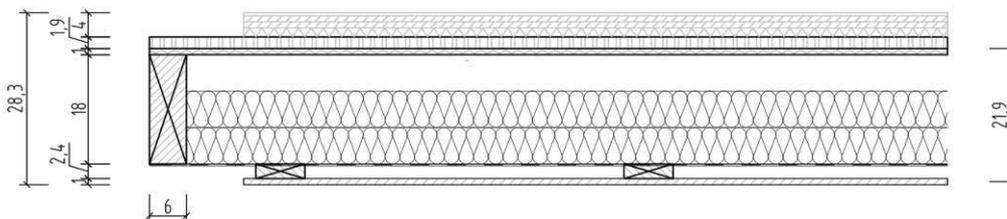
Geschoßdecke Haus B (Quelle: eigene Darstellung)
